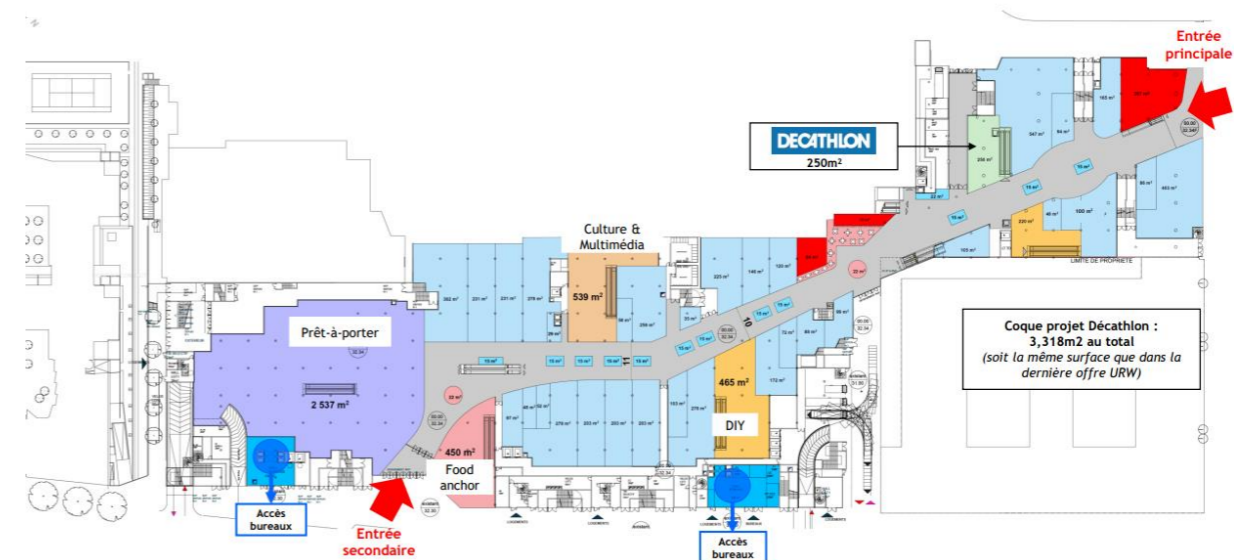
Projet 2019 : vue en plan du rez-de-chaussée (Source : WO2)
